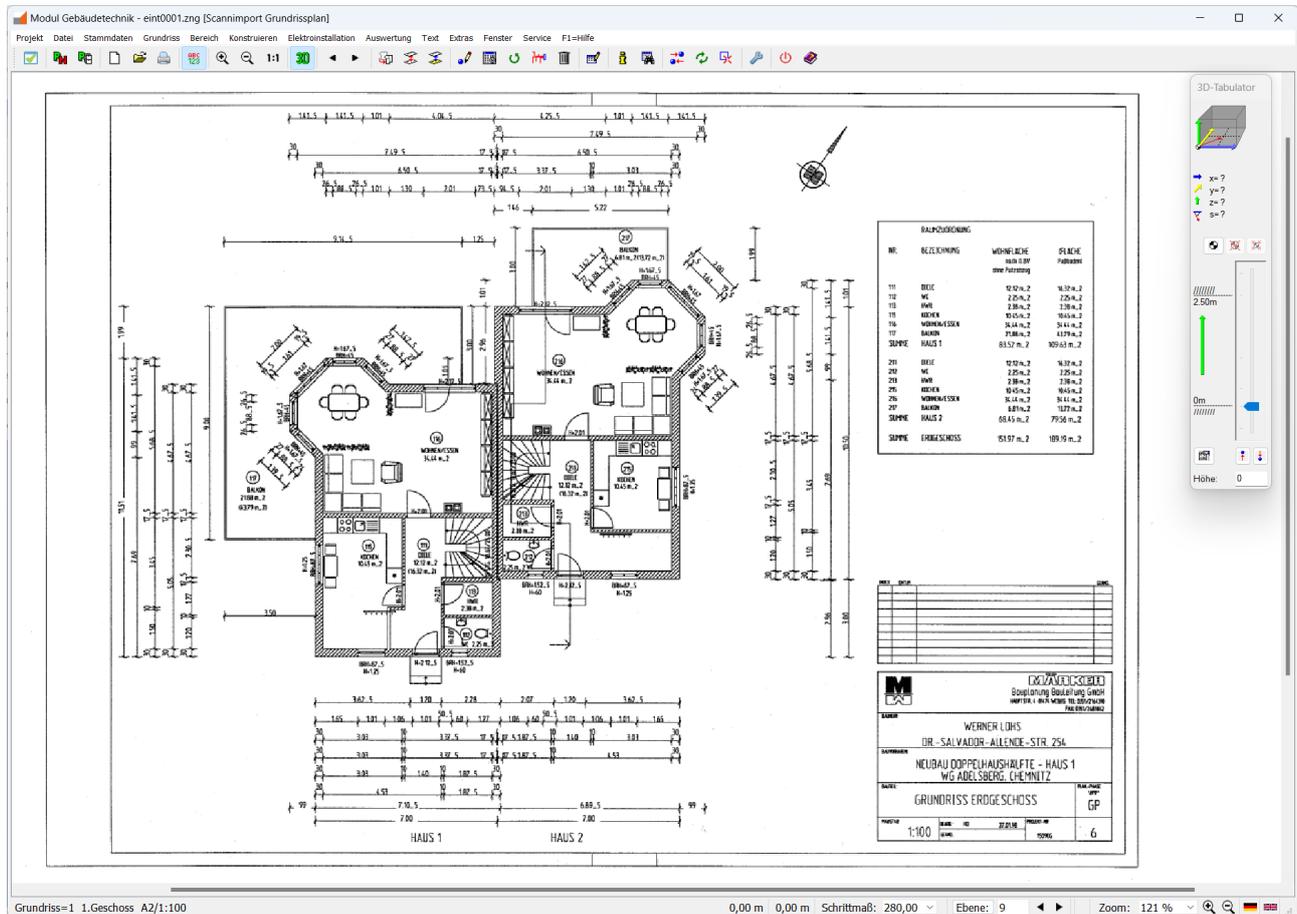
Importierter gescannter Grundrissplan
